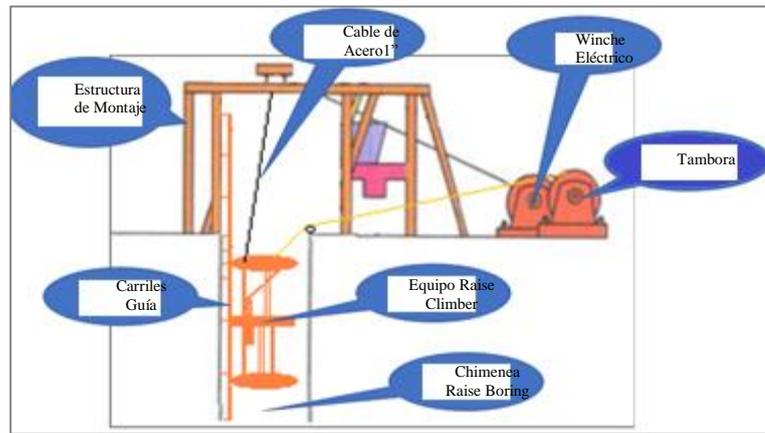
3 Perfil de Montaje de Equipo Raise Climber
